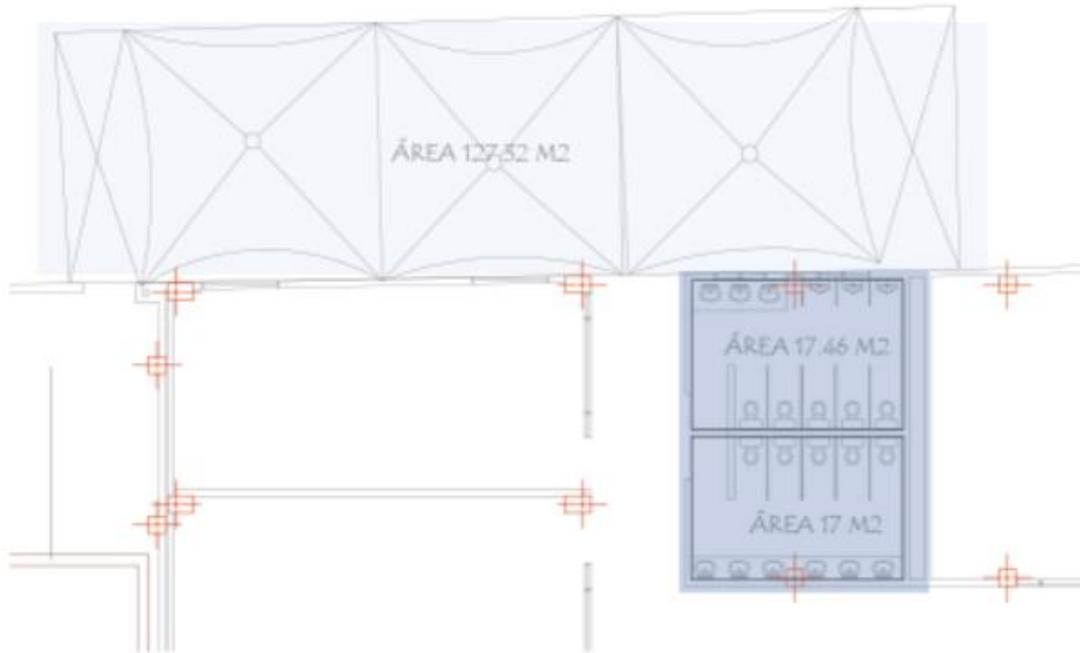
Plazoleta cubierta bloque I, Planimetría suministrada por parte de la planta física de la universidad la Gran Colombia
